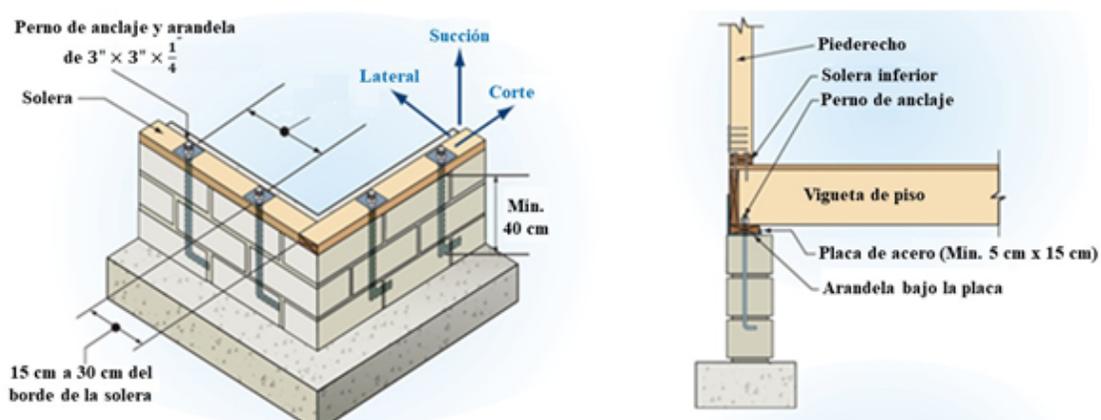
Detalle anclaje contra sobrecimiento en bloque estructural (American Wood Council, 2015)
